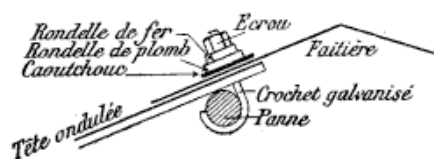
Assemblage des tôles avec la faitière sur panne.
